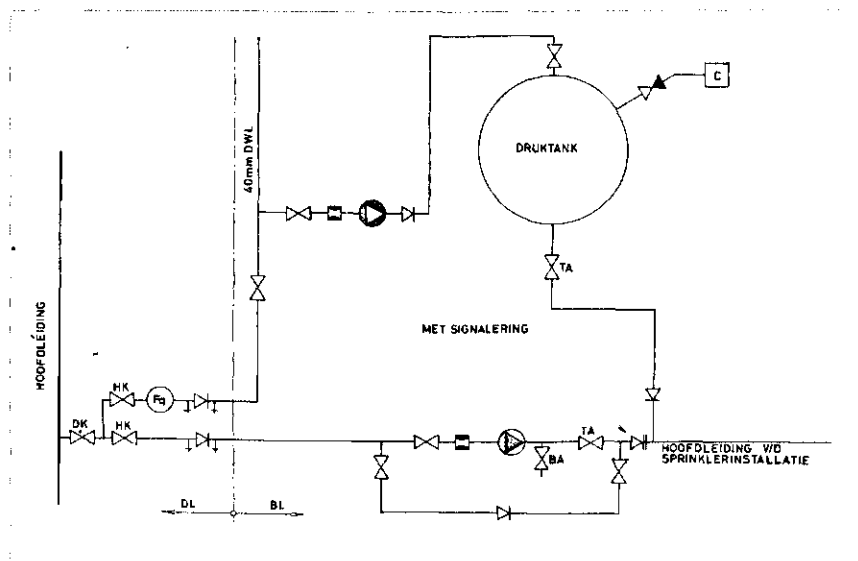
Onderbroken aangesloten sprinklerinstallatie.
